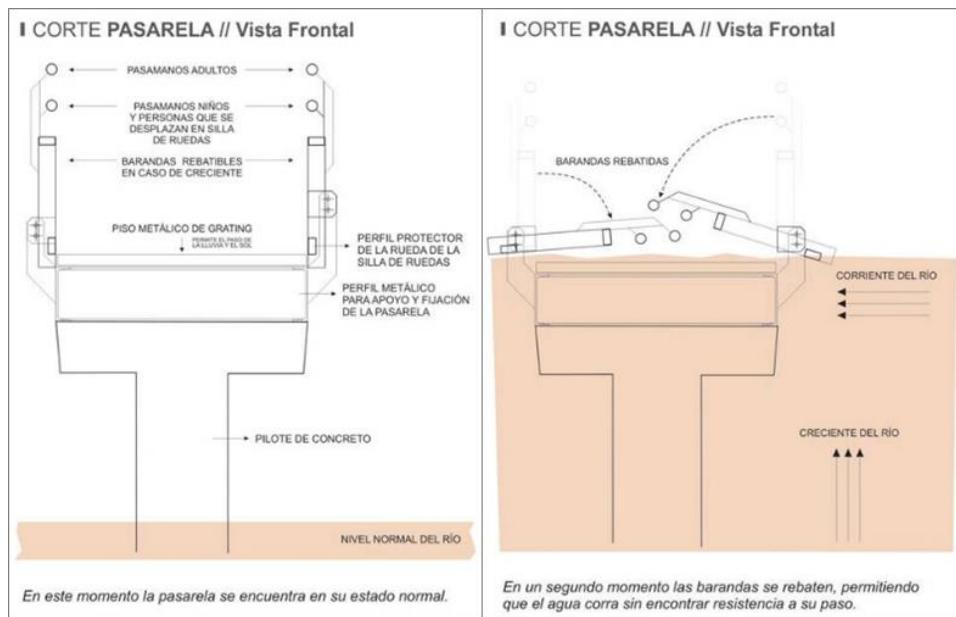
Detalle del diseño de las pasarelas rebatibles
